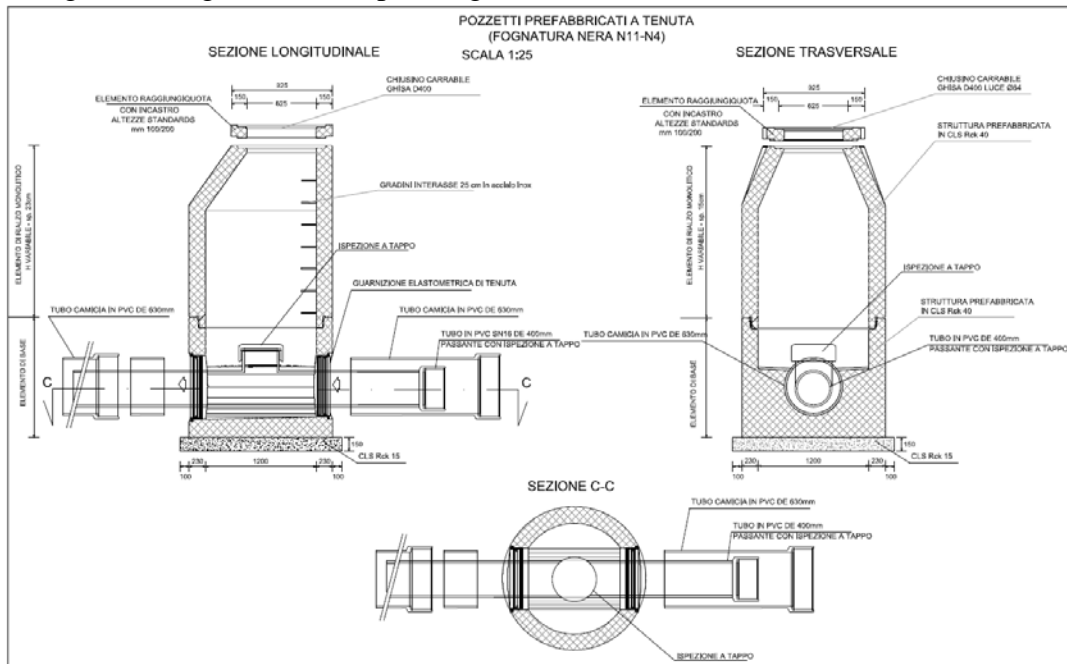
Pozzetti prefabbricati a tenuta nel tratto di interferenza con la zona di rispetto allargata
